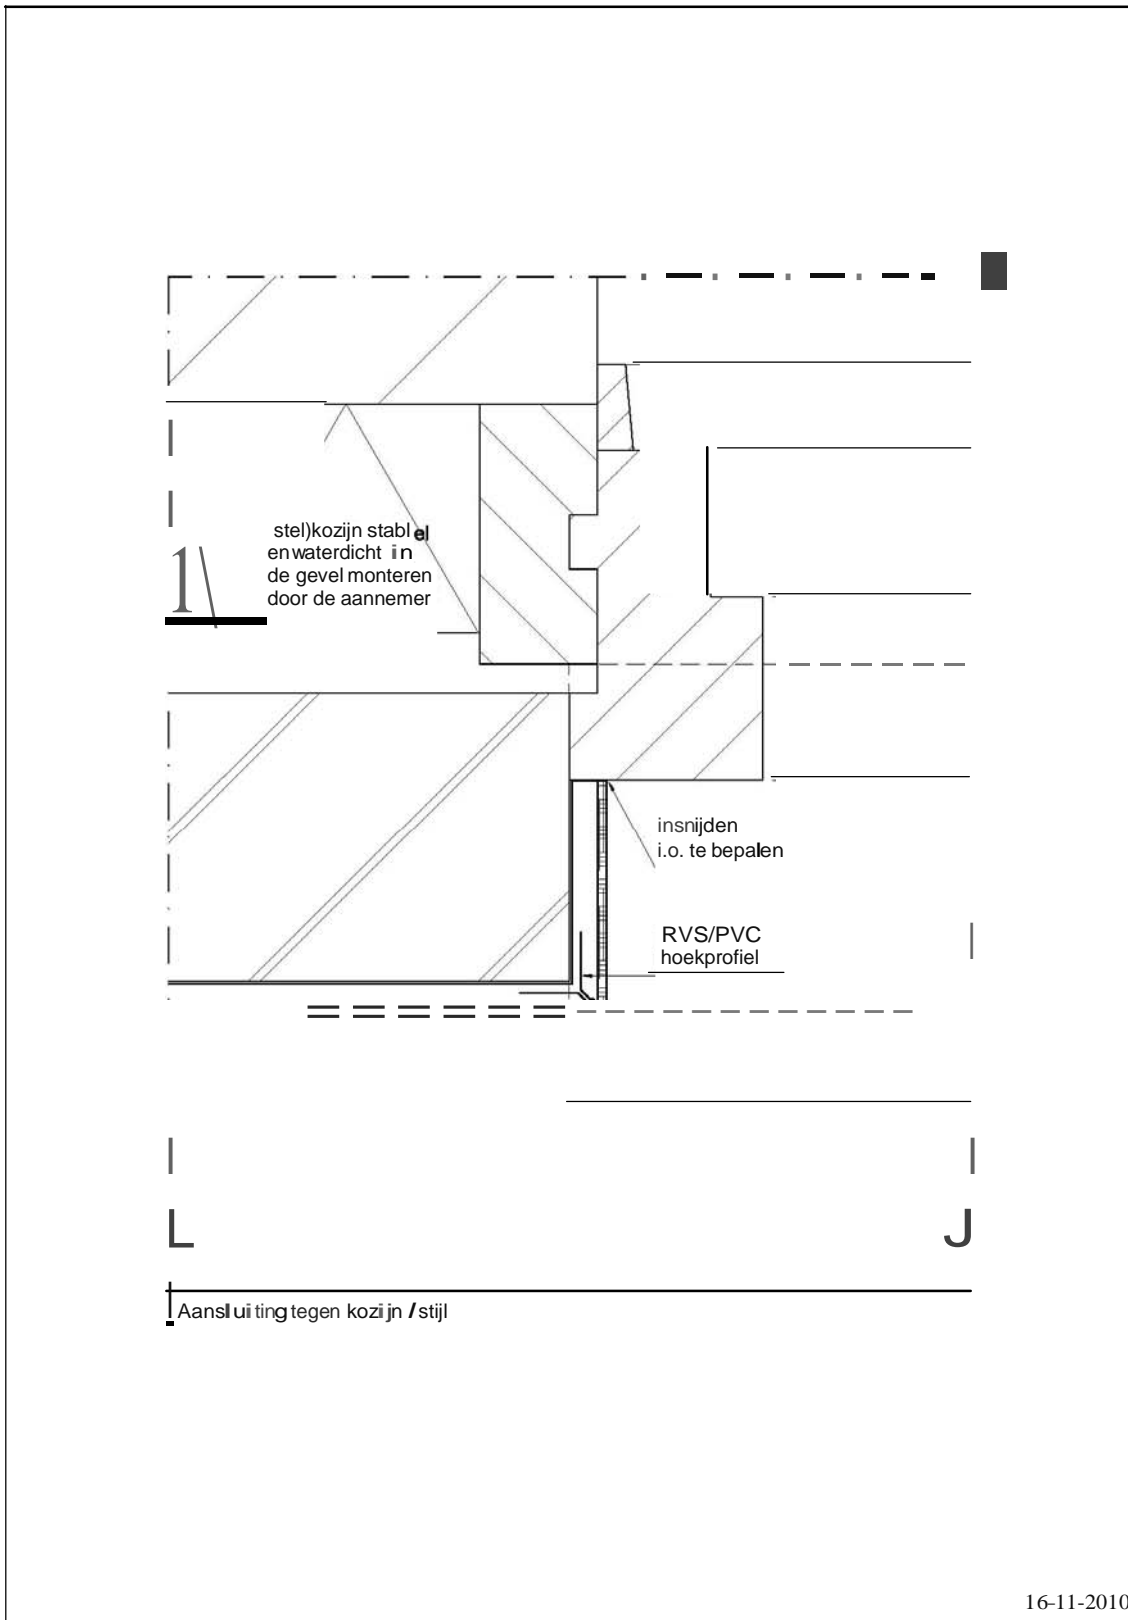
Aansluiting tegen een kozijn-bovendorpel
